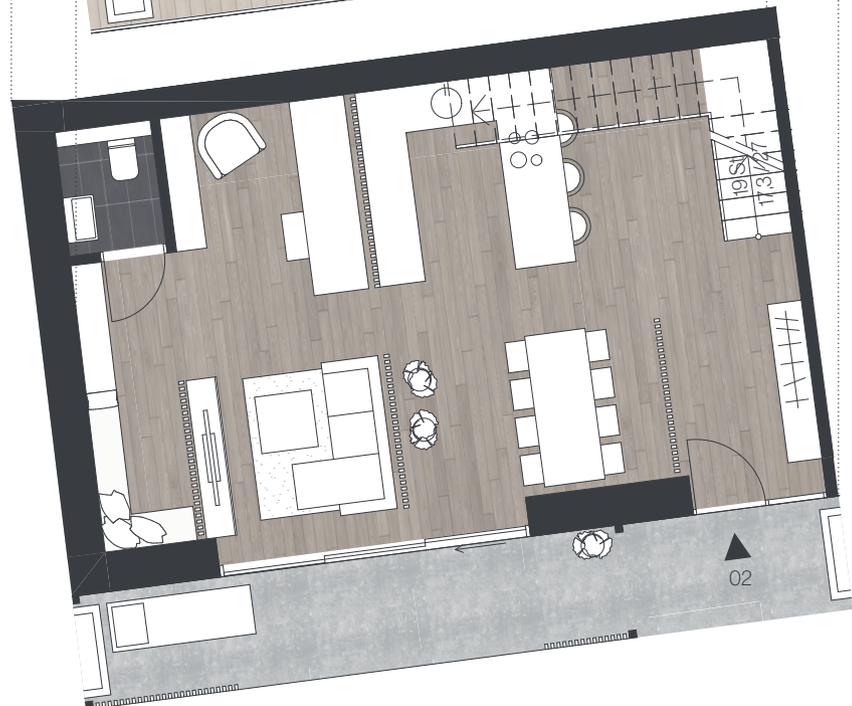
| Grundriss Erdgeschoss. Wohnung 01
